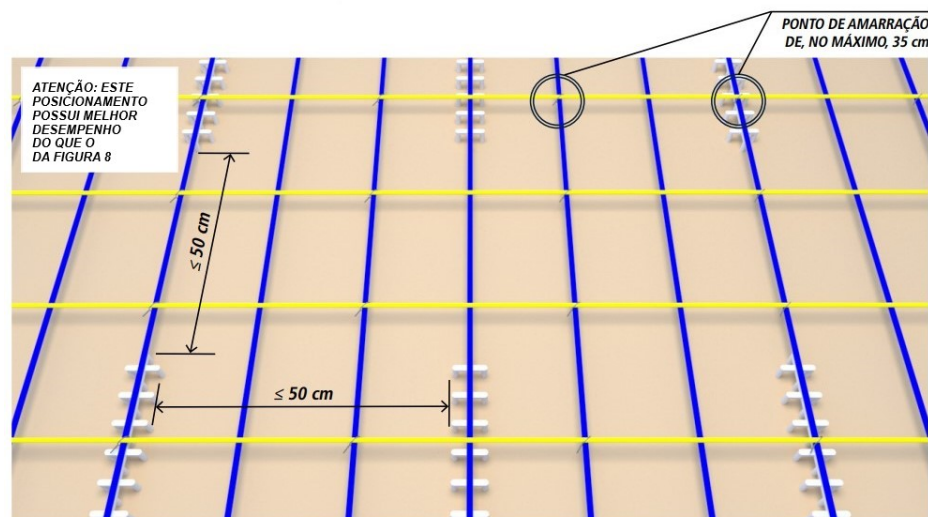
Posicionamento dos espaçadores em lajes - espaçadores longitudinais às barras.
